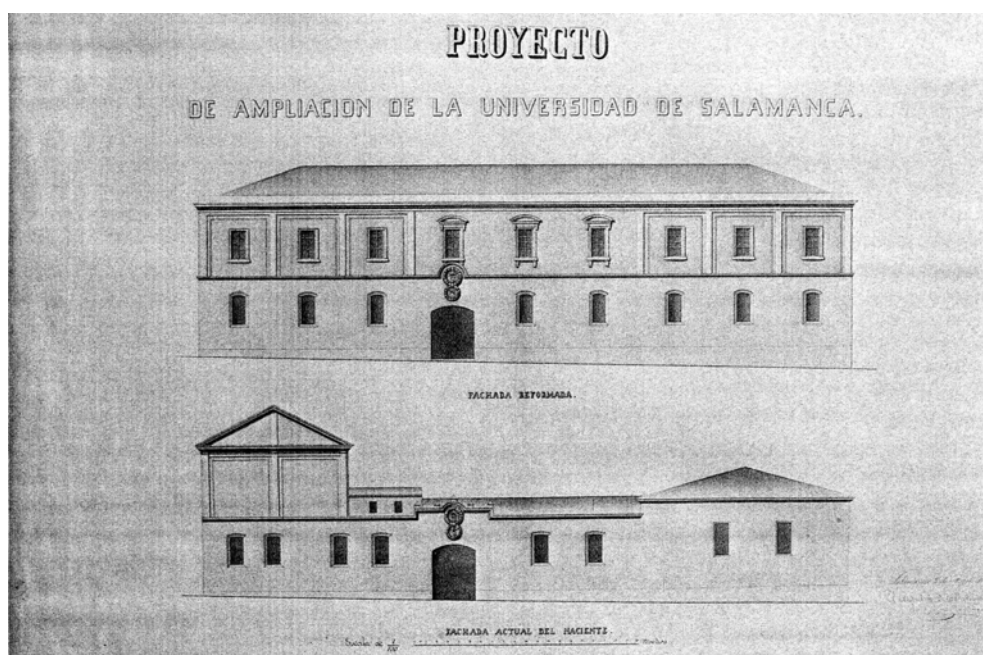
Reforma de la fachada oriental tras el aumento de altura realizado por Secall
